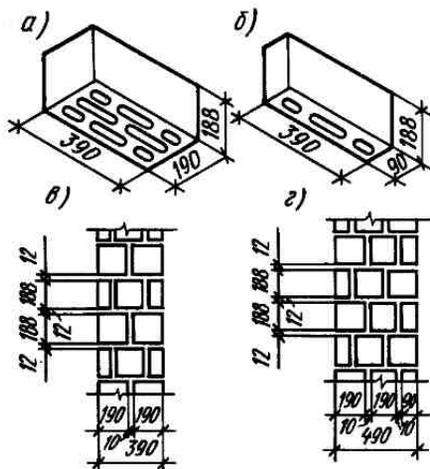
Стена из легобетонных камней с щелевидными пустотами:
